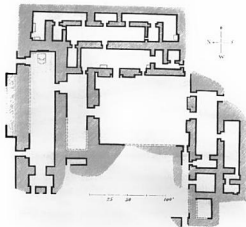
Grundriss des Nordwestpalastes von Nimrud.
